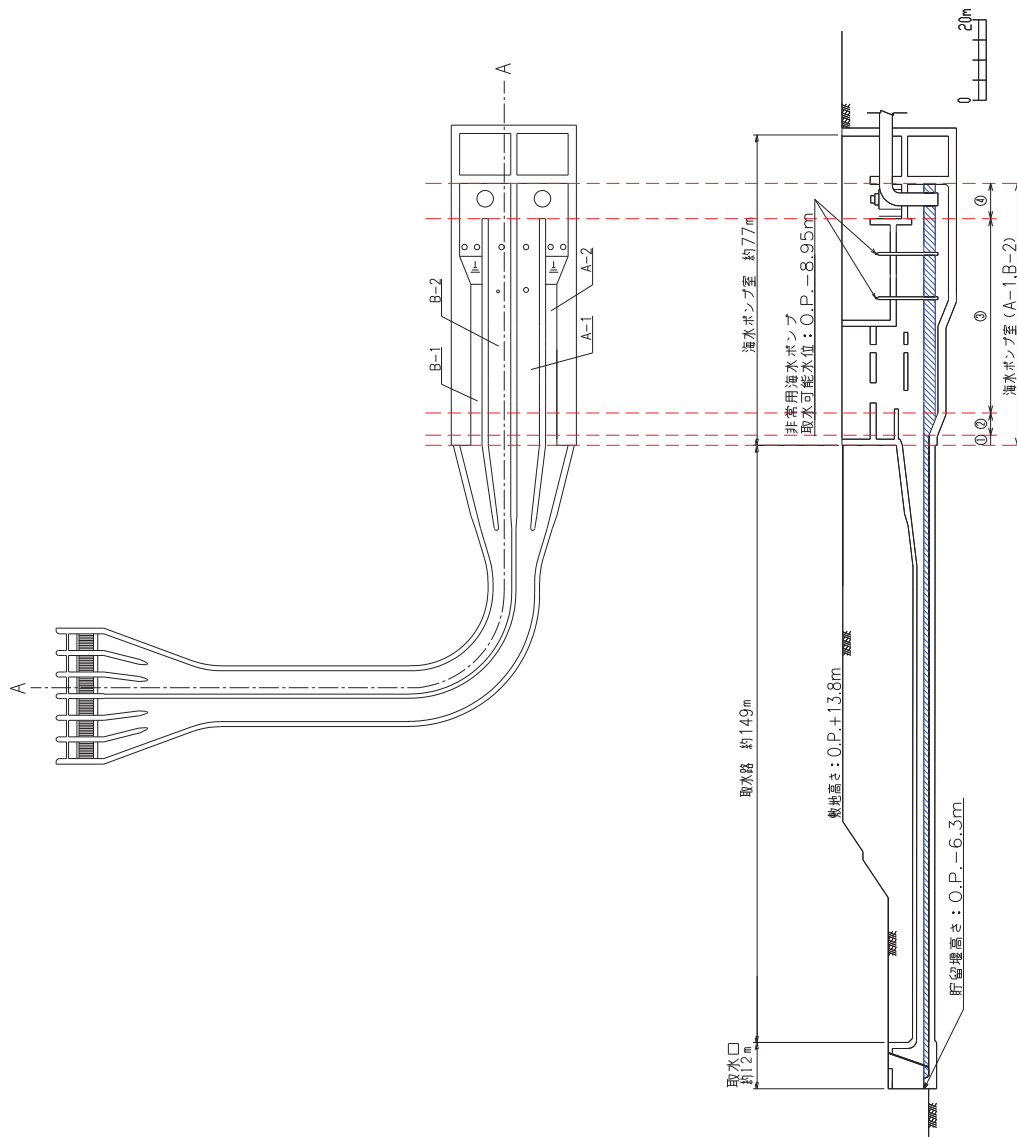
(2) 非常用取水設備の平面図及び縦断面図 (A-A) (海水ポンプ室 (A-1, B-2))
